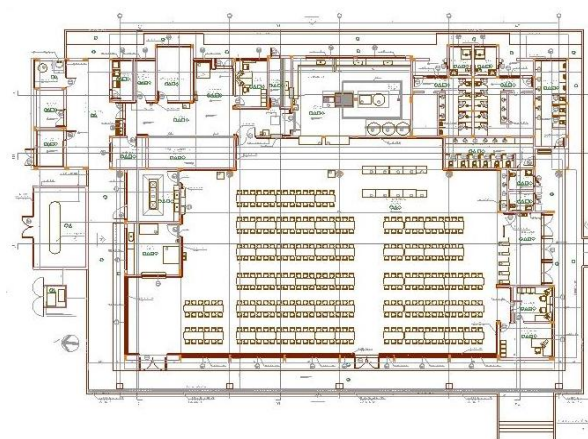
Planta baixa do interior do Restaurante com alocação de mobiliário.
